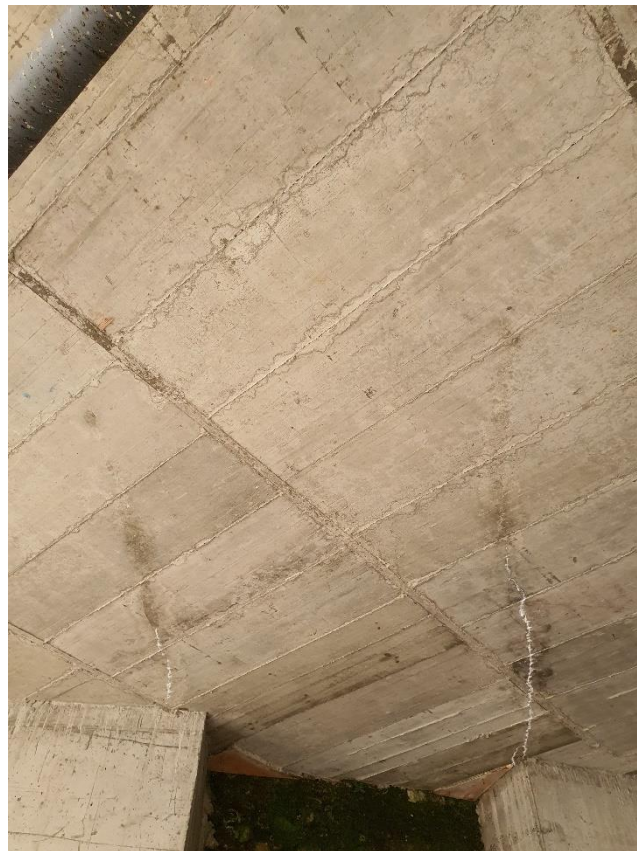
Vista general donde se observan fisuras horizontales con eflorescencias por sales en la cara inferior del techo del sótano -1
